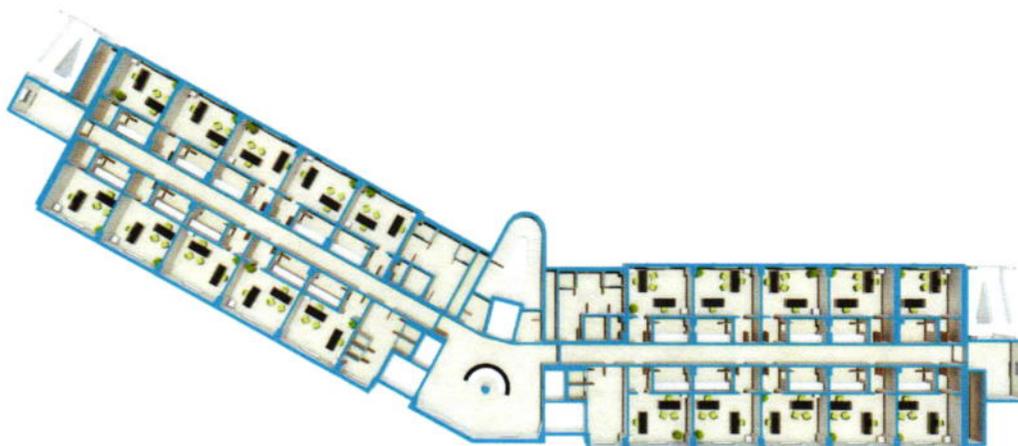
Ipotesi 01 - Planimetria piano tipo.
